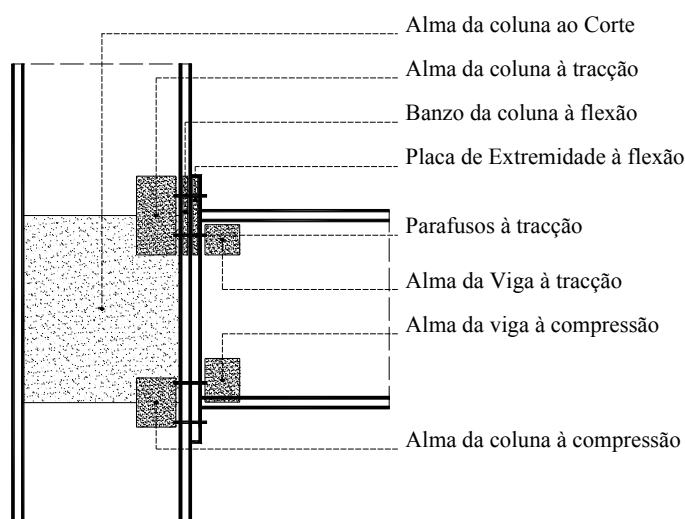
Componentes da ligação viga-coluna, com placa de extremidade.
